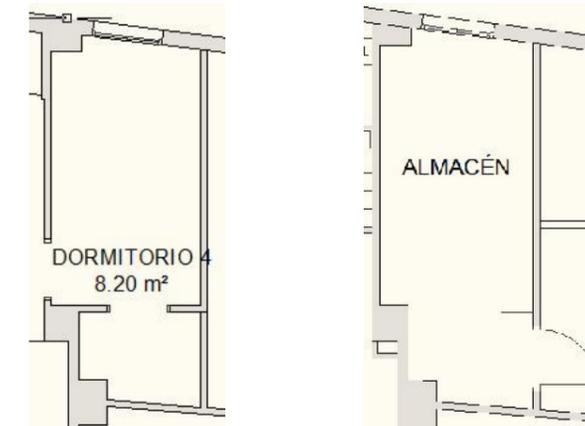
Dormitorio 4 Actual y propuesta de Almacén. Fuente: propia autora
